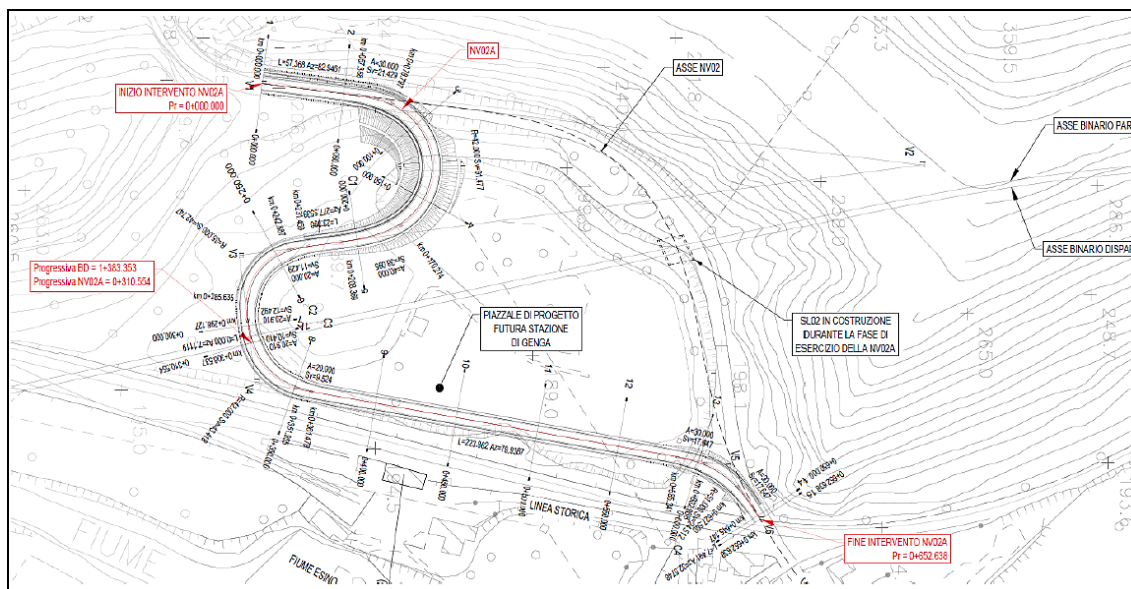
Deviazione provvisoria via Marconi - Stralcio planimetrico
